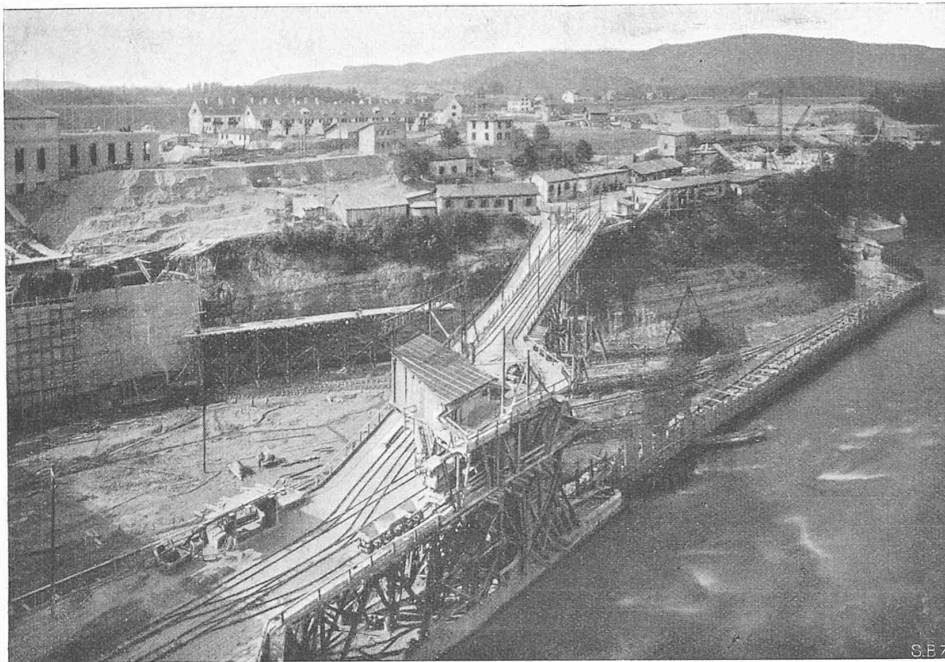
Lagerplatz am linken Rheinufer, mit Gerüstbrücke und Betonieranlagen für das Stauwehr.
